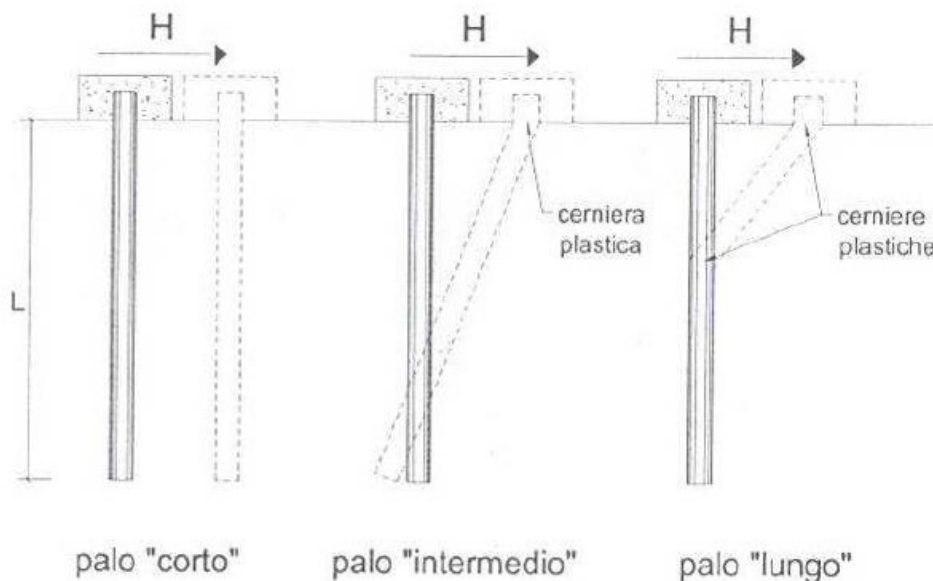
Rottura per carichi orizzontali – possibili meccanismi di rottura
